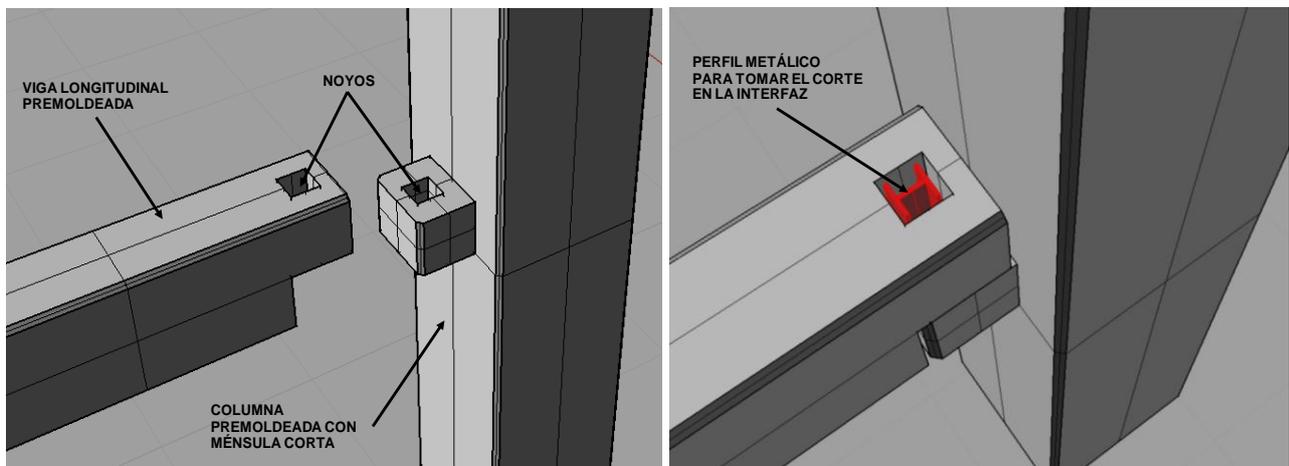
Esquema de conexión entre la viga longitudinal y la columna
